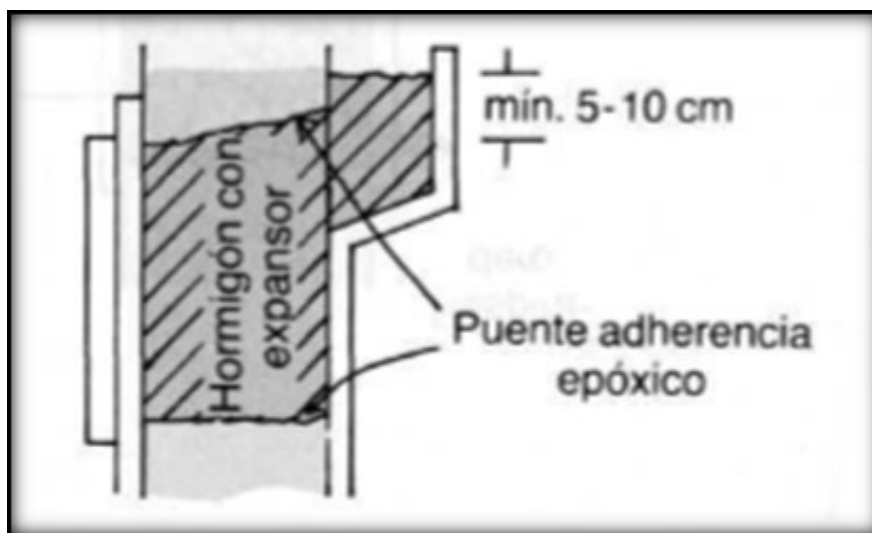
Puente de adherencia. Fuente. Constructora Colpatría
